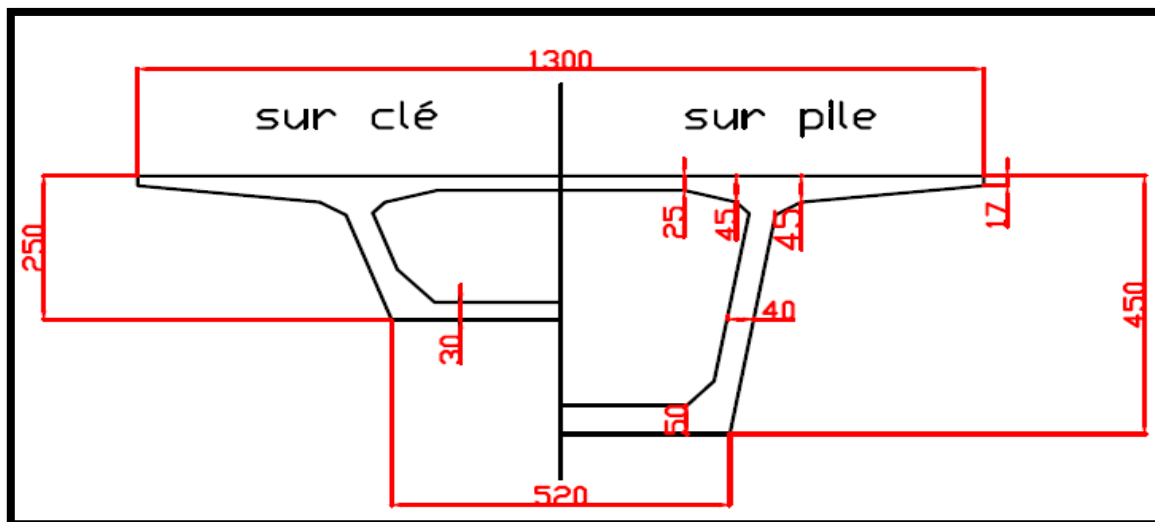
section transversale de voussoir sur pile et sur la clé.
